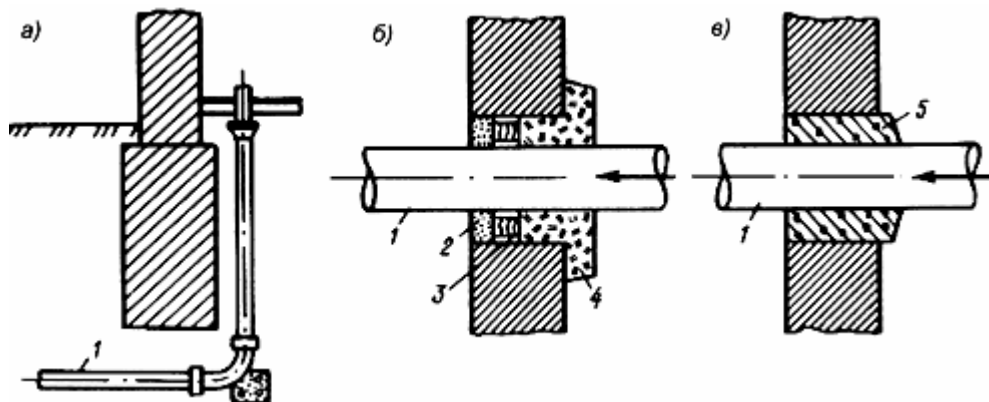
Пересечение вводами фундаментов или стен сооружений и зданий
